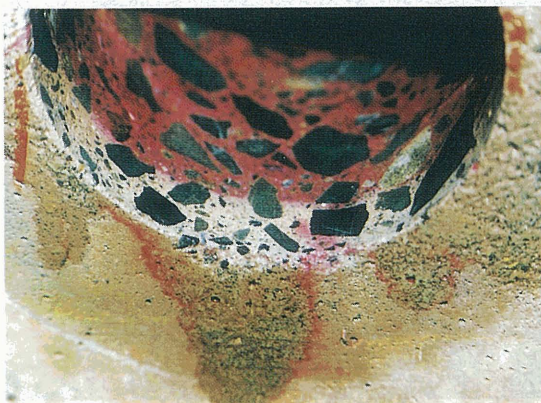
建物基礎のコンクリートにおける炭酸化の進行
